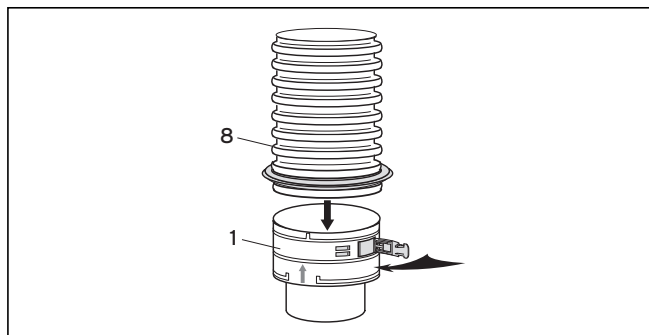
Montaż giętkiego przewodu spalinowego i uszczelnienia
